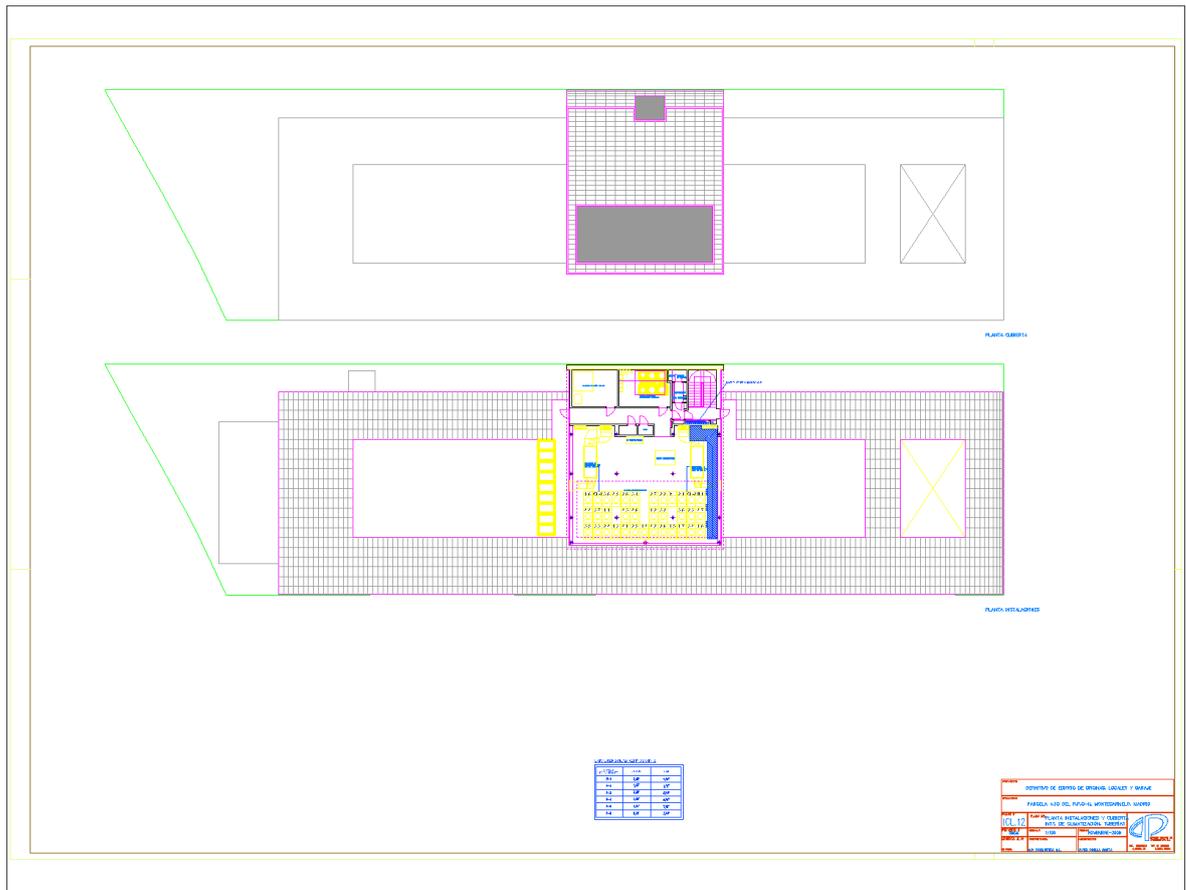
Plano de la cubierta del Edificio Monteolmo. Fuente AutoCAD
